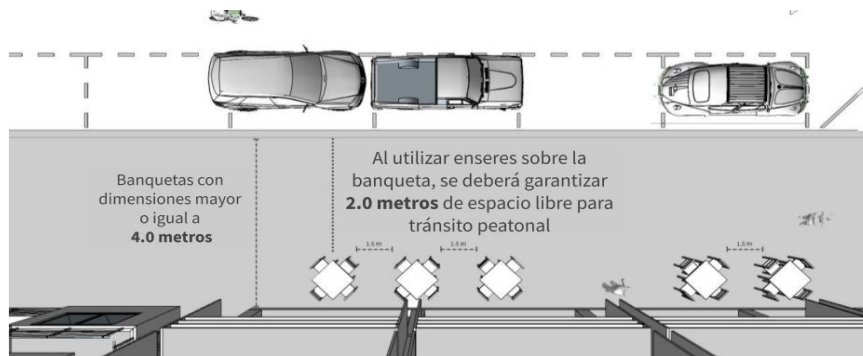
Colocación de enseres en banquetas con un ancho igual o mayor a 4.0 metros
